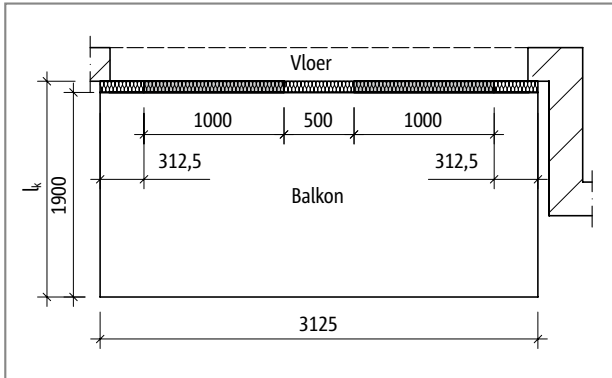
Schöck Isokorb® T type K-E: Aansluiting van prefabbalkons met plaatdikten van 160 mm tot 200 mm met IDock2
